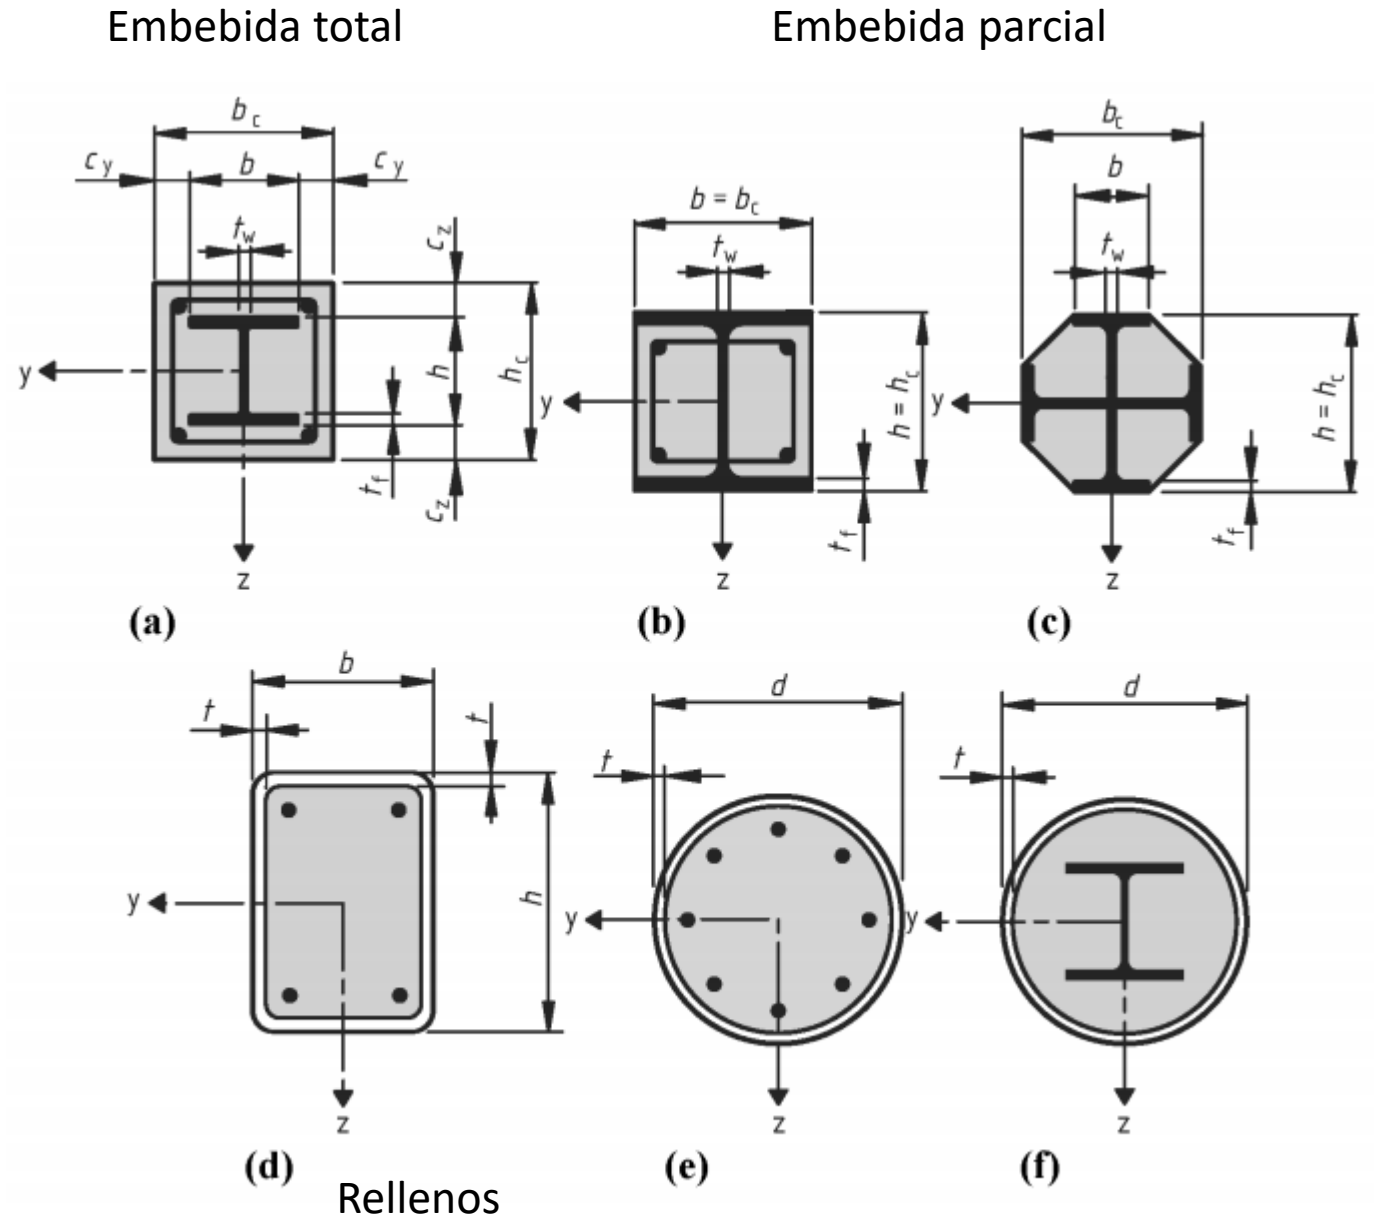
Secciones tipo de pilares mixtos y símbolos
